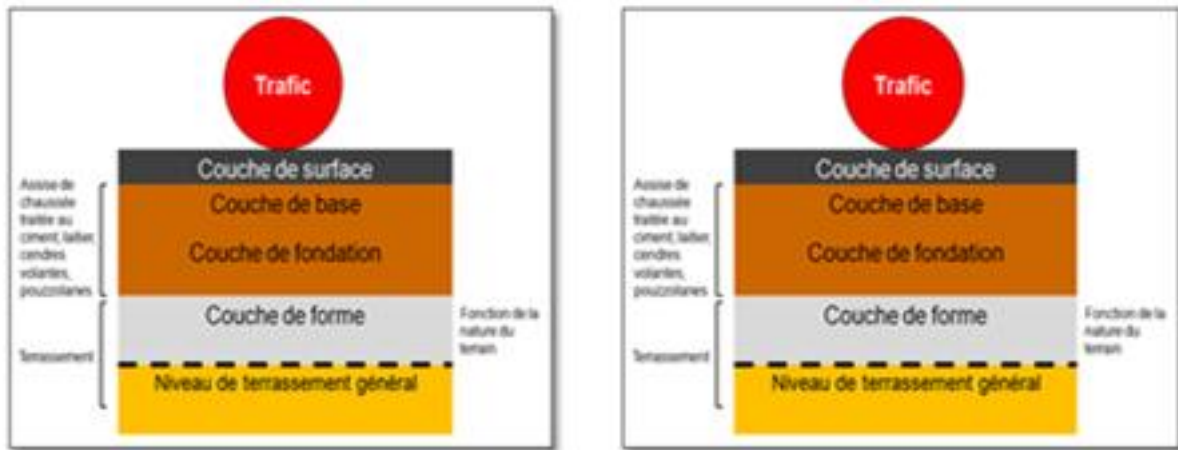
Structure type d'une chaussée semi-rigide.
